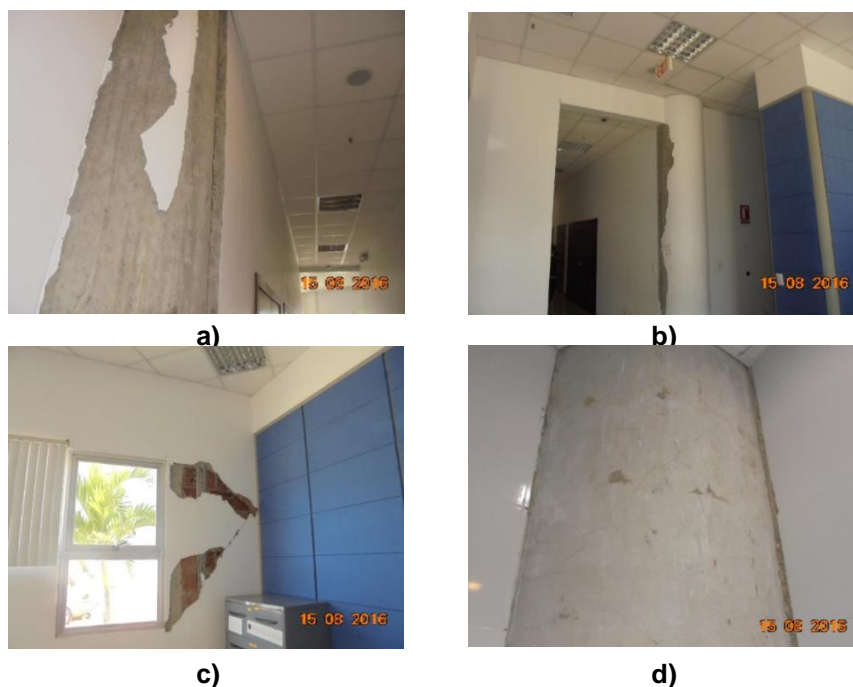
a) Caída de enlucido en columnas circulares; y b) Enlucido muy grueso; c) Fisuras en recubrimiento de columna; d) Daño en Mampostería. Fuente: Aguiar *et al.* (2016,1).
